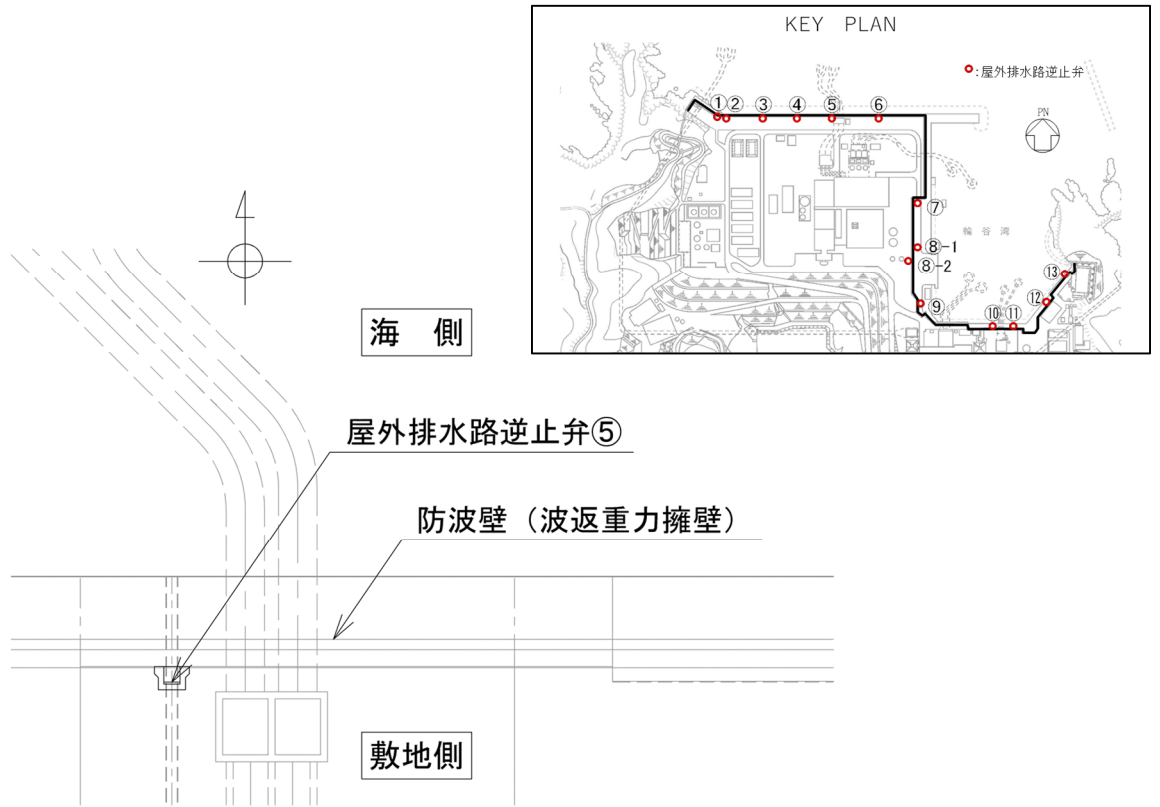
(1) 屋外排水路逆止弁⑤平面图
